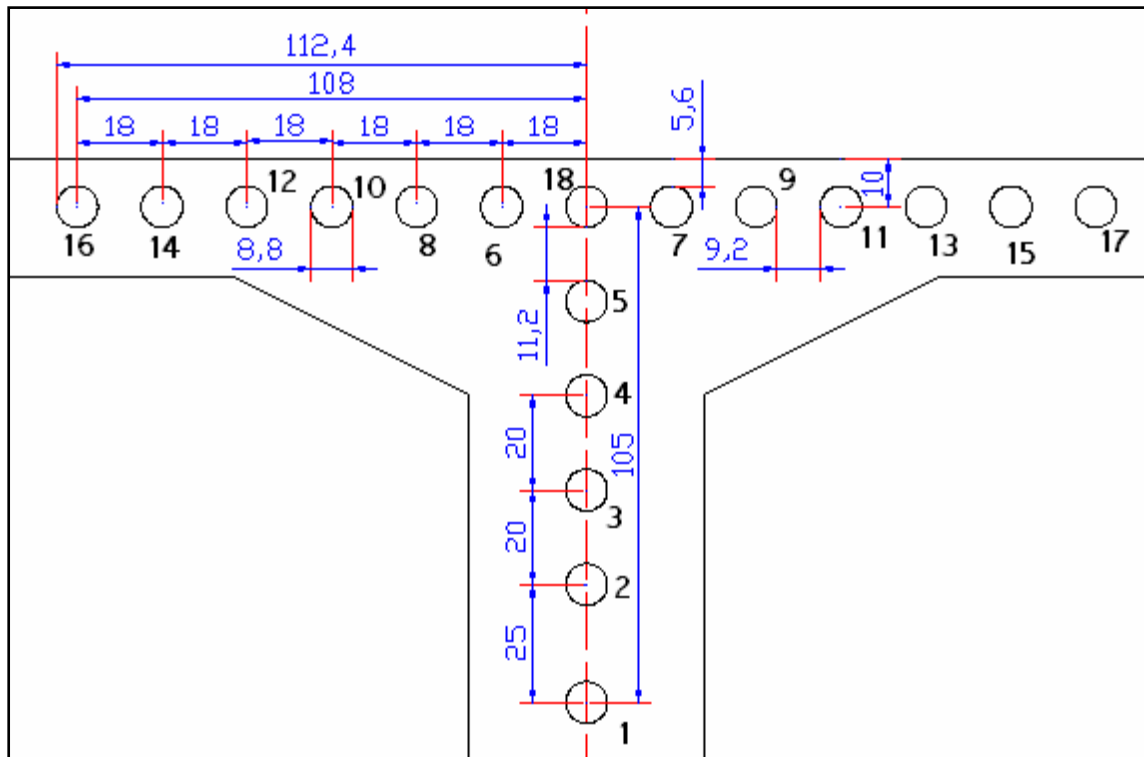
Disposition des câbles au niveau de la section sur pile
